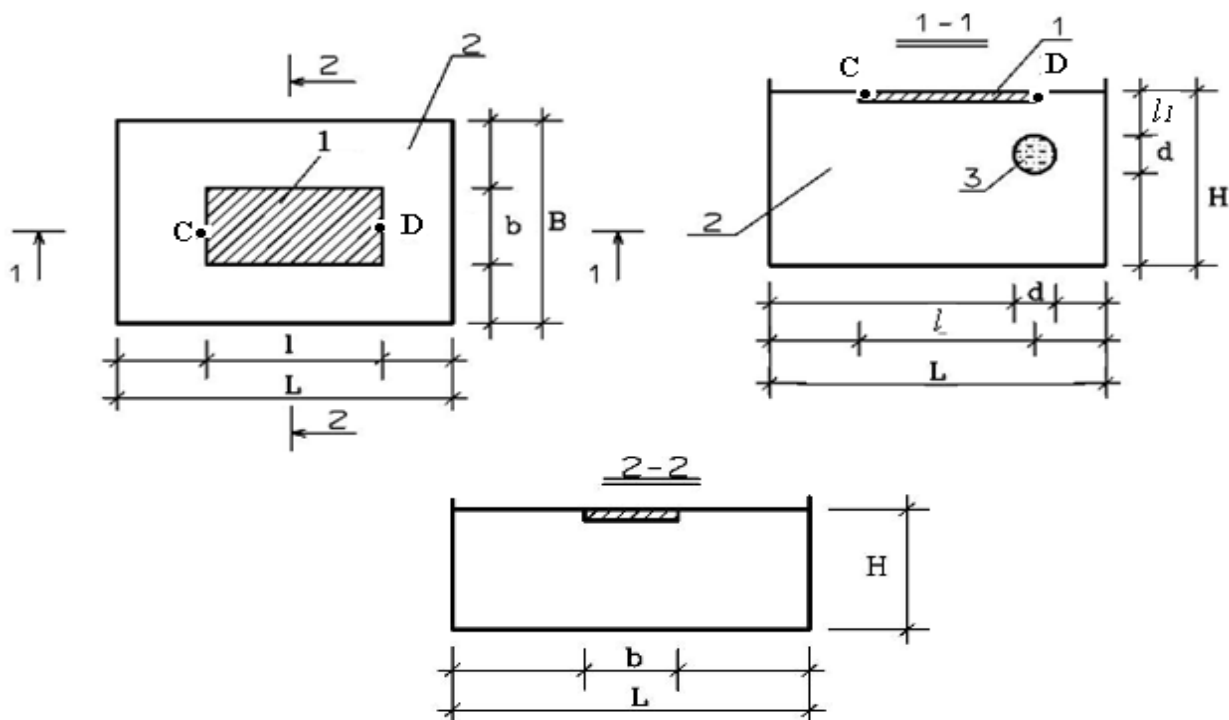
Схема системы «Грунтовый лоток – основание - фундамент».
